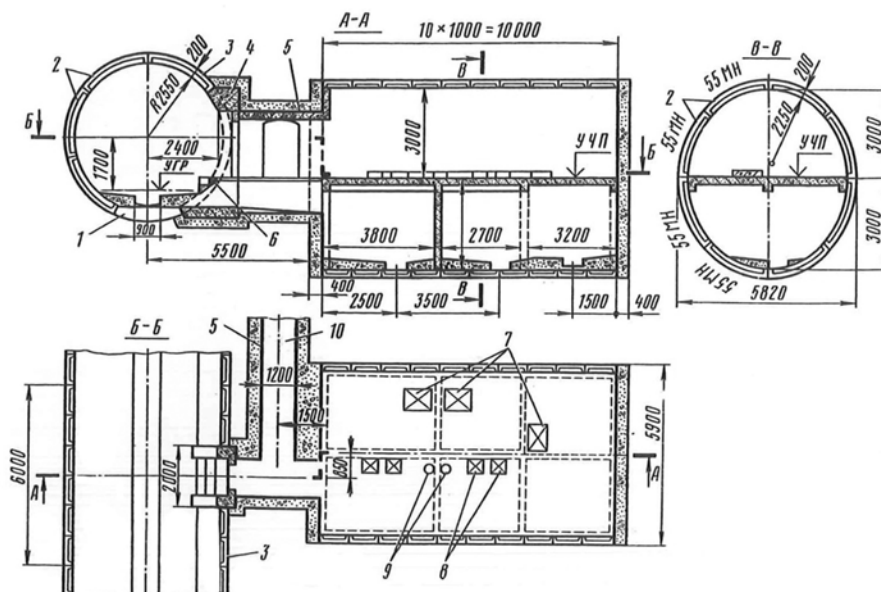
Камера водоотливной установки закрытого способа работ с обделкой из унифицированных ребристых железобетонных блоков, расположенная сбоку перегонного тоннеля: 1 — лотковый железобетонный блок; 2 — нормальные блоки; 3 — железобетонная обделка из ребристых блоков; 4 — монолитная железобетонная рама; 5 — клеенчатая или металлическая гидроизоляция; 6 — входные ступени; 7 — люки 900 × 700 мм; 8 — люки 500 × 500 мм; 9 — люк D=400 мм; 10 — проход в прикамерок буровой скважины
